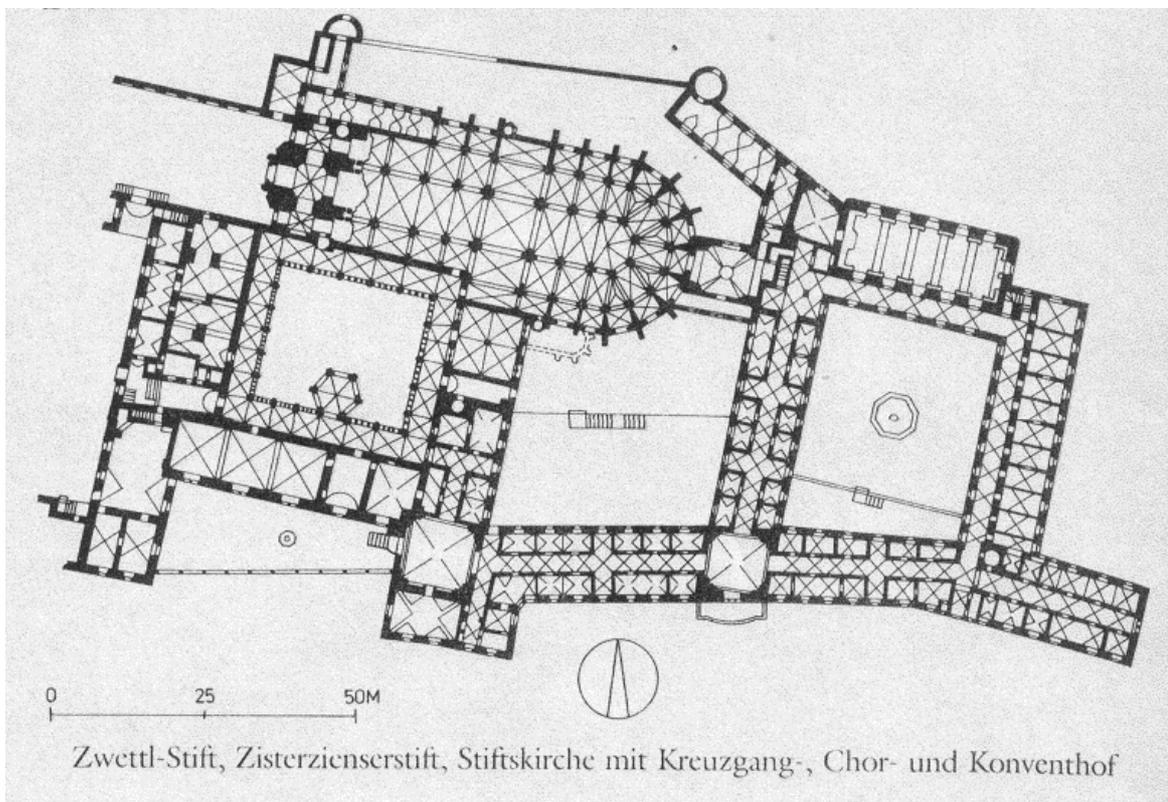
Zwettl, Zisterzienserstift Zwettl, Grundriss, Ausschnitt
